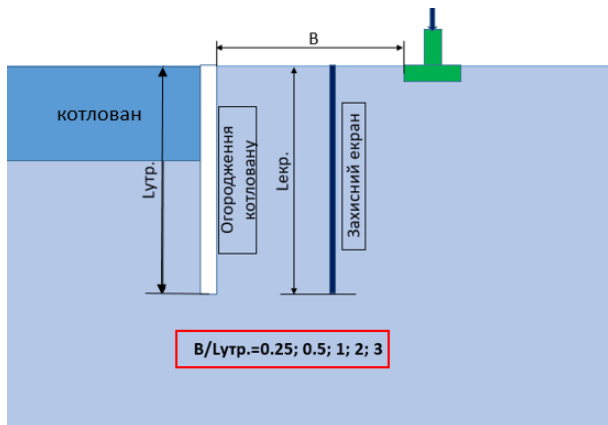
Розрахункова схема при дослідженні впливу відстані між існуючою будівлею та котлованом
